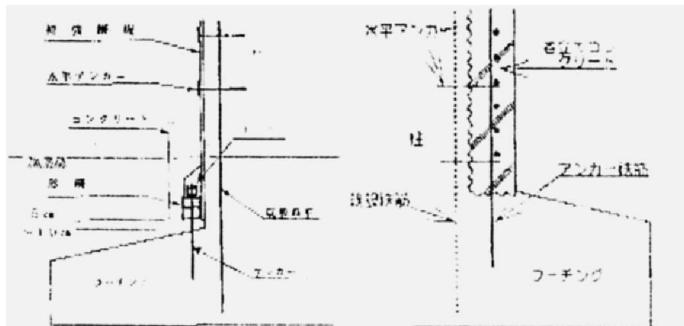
曲げ耐力制御式鋼板巻立て工法 図-2 鉄筋コンクリート巻立て工法
